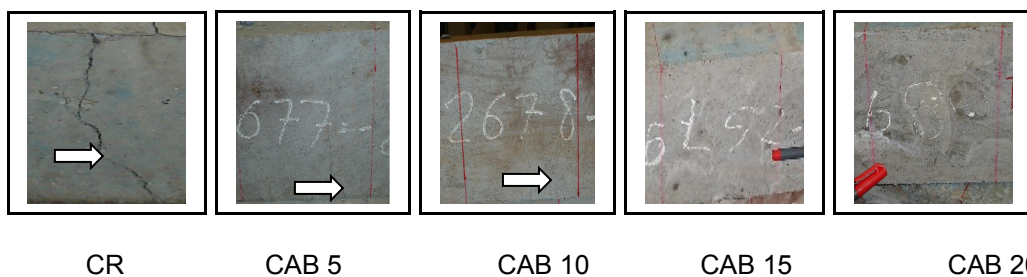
FISSURAS DEVIDO AO CARREGAMENTO EM CORPOS-DE-PROVA PRISMÁTICOS.
